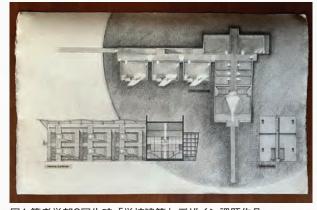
筆者学部3回生時「学校建築」デザイン課題作品 1F平面配置図、断立面図
